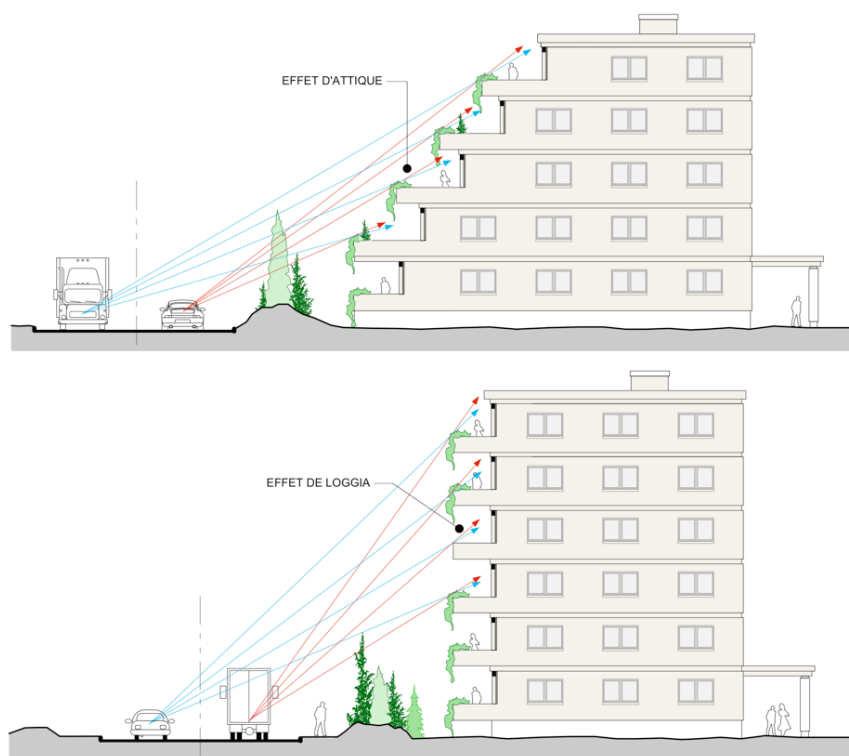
b : Protection d'un immeuble en hauteur à l'aide de loggias et d'attiques
